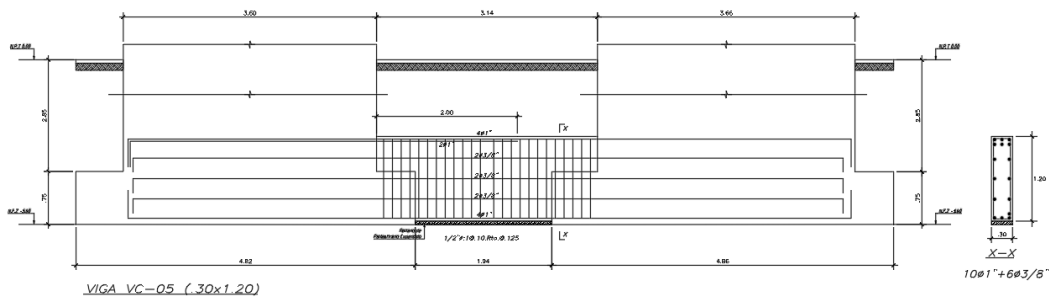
Diseño final de la viga de cimentación VC-05 para sistema de muros
